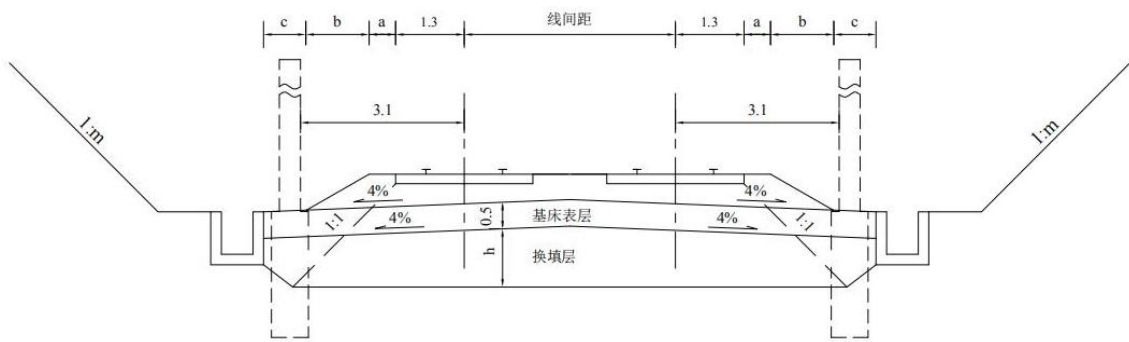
有砟轨道双线非硬质岩路堑横断面图 (单位: m)
